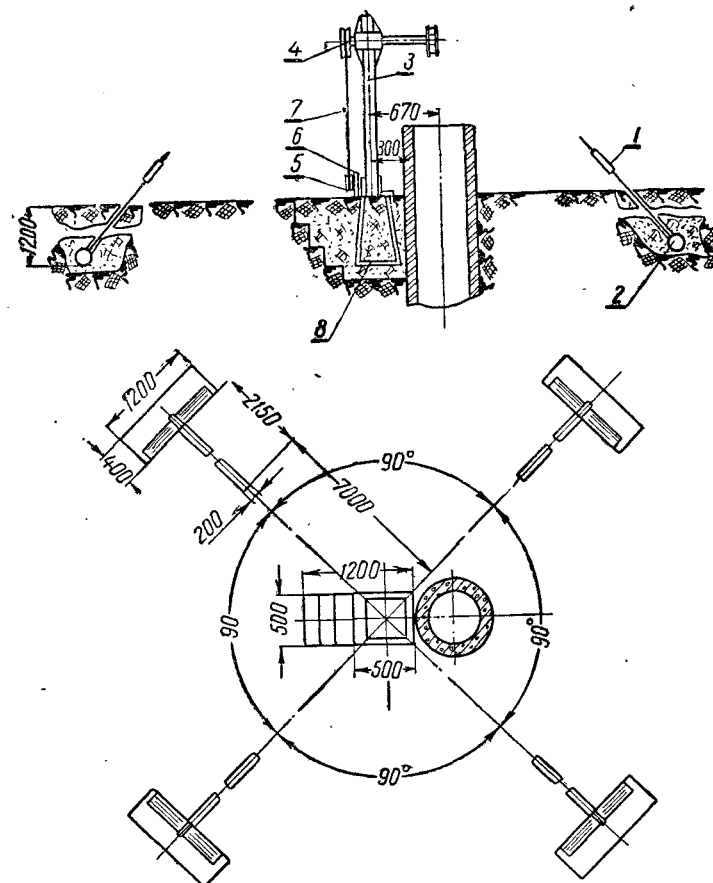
Площадка для монтажа ветроводоподъемника ВП-3М:
